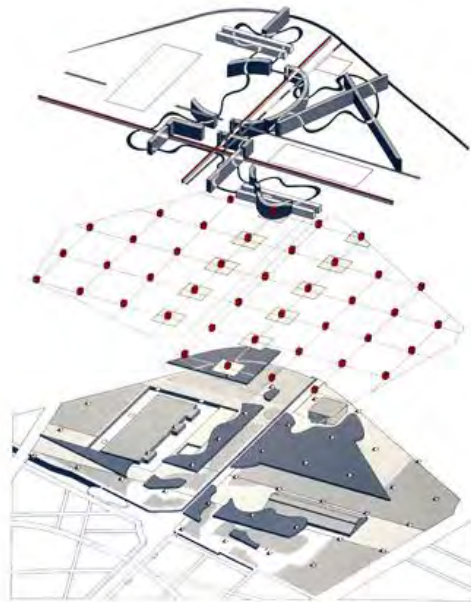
Site Plan Parc de La Villette (Pinterest.com, 2016)
